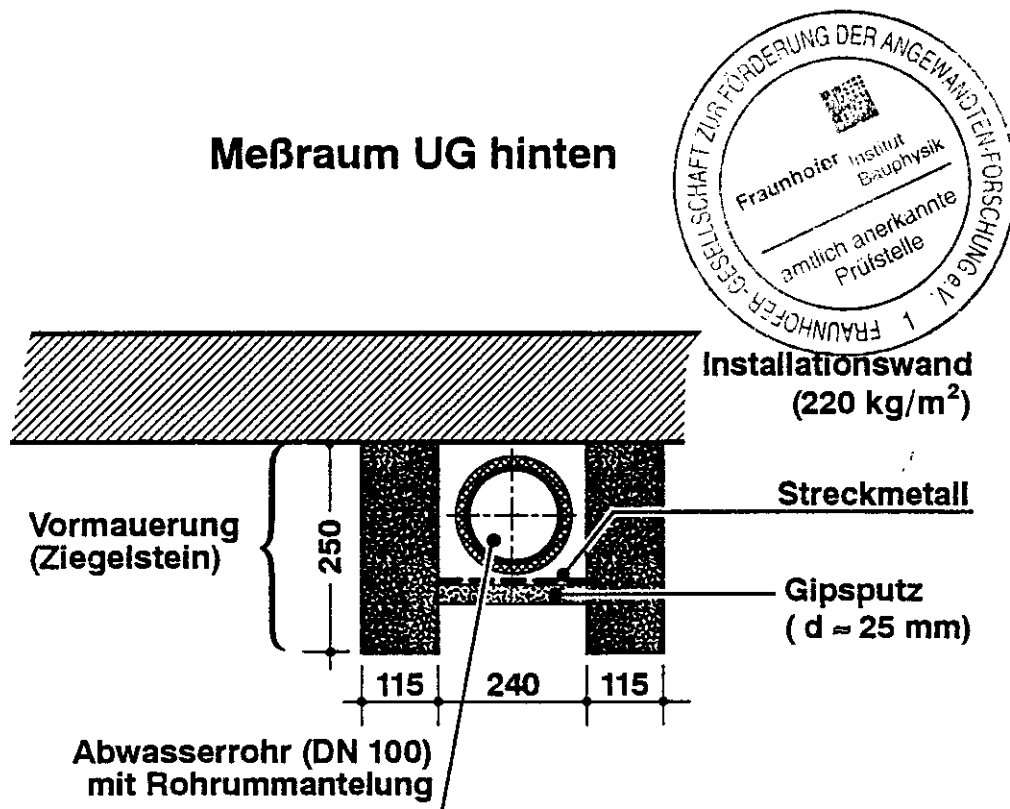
Skizze des untersuchten Meßaufbaus (Horizontalschnitt im Untergeschoß des Installationsprüfstandes)
